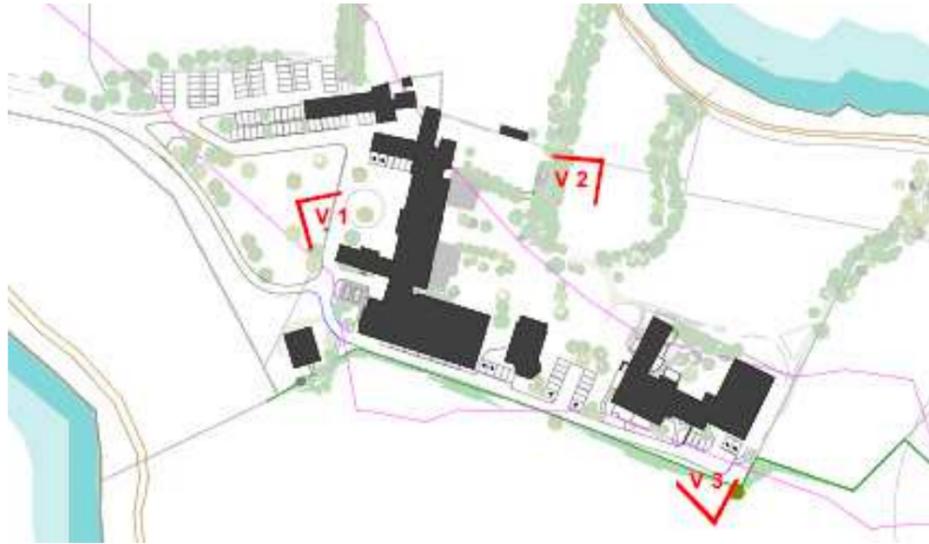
Plan masse Laënnec/La Voilerie (Source : Paumier Architectes Associés)
